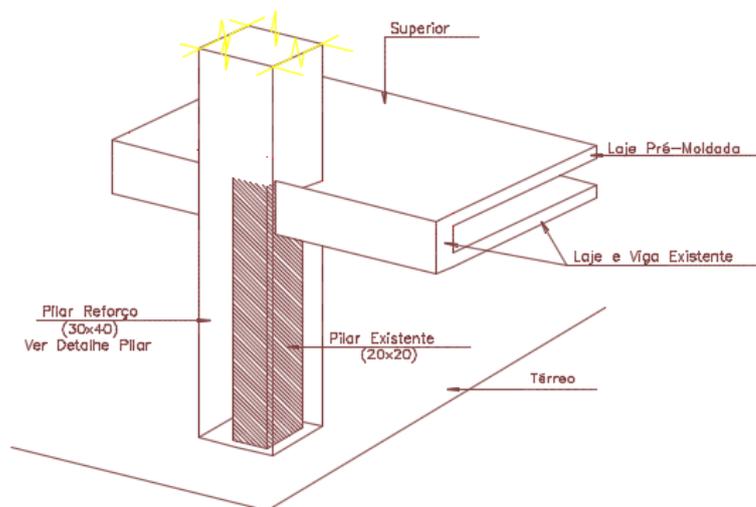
Detalhe do reforço nos pilares e adição de laje pré-moldada.
